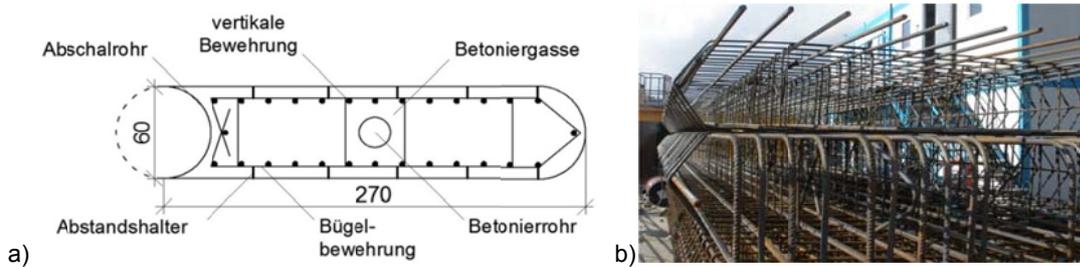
Bewehrungseinbau im Querschnitt – a) Schema; b) Photo<sup>79</sup>
